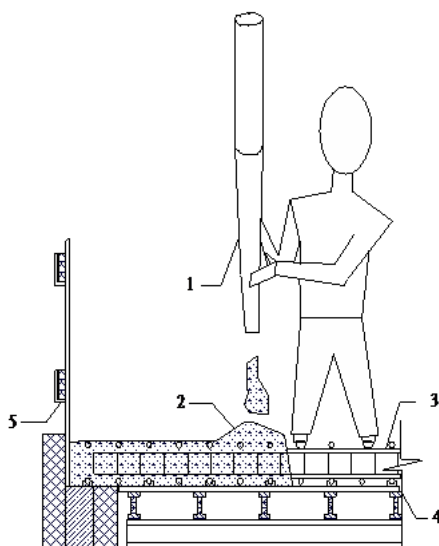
Укладка бетона: 1 — наконечник стрелы автобетононасоса; 2 — укладываемый бетон; 3 — армирующая сетка; 4 — конструкция опалубки перекрытия; 5 — инвентарное ограждение
